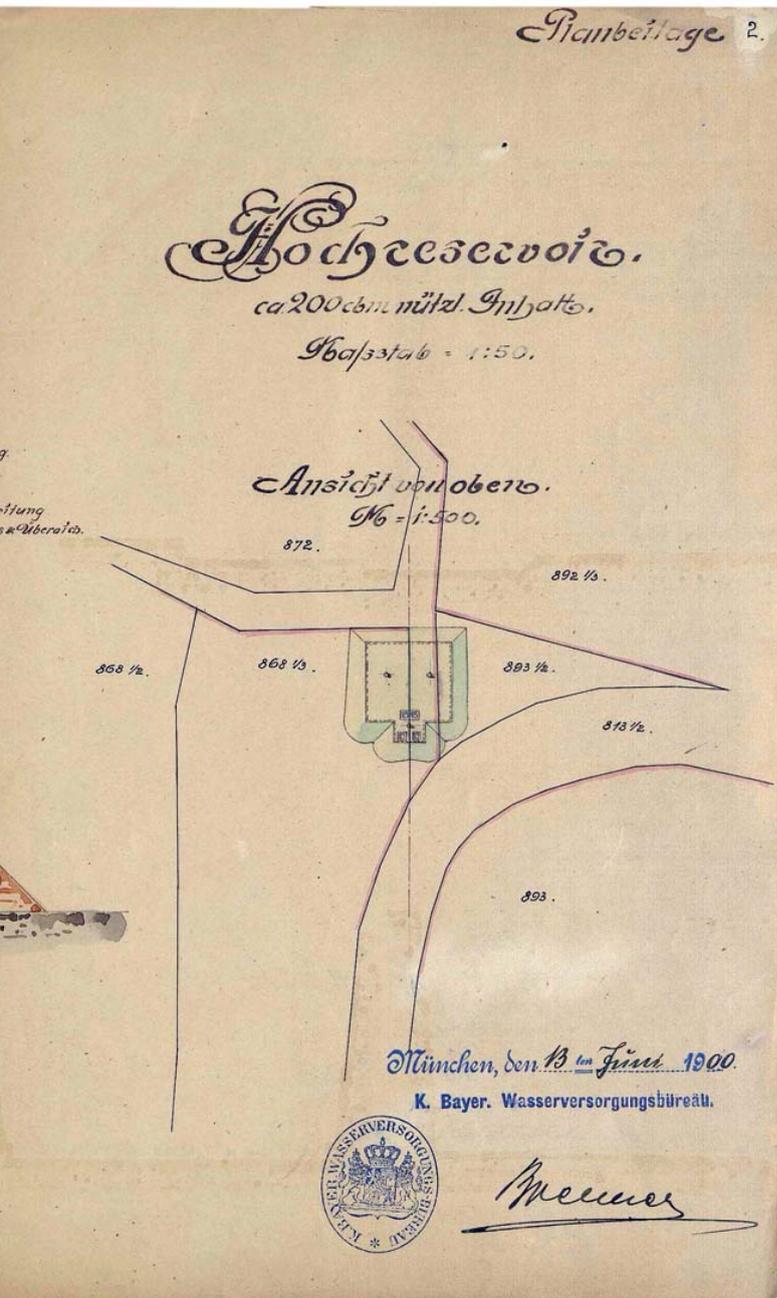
Plan zum Bau eines Wasserspeichers am Schönberg 1900 (Ausschnitt)
